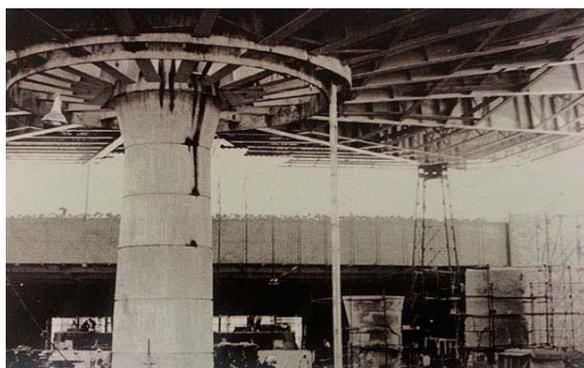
Construcción de la cubierta del patio del M.N.A.
